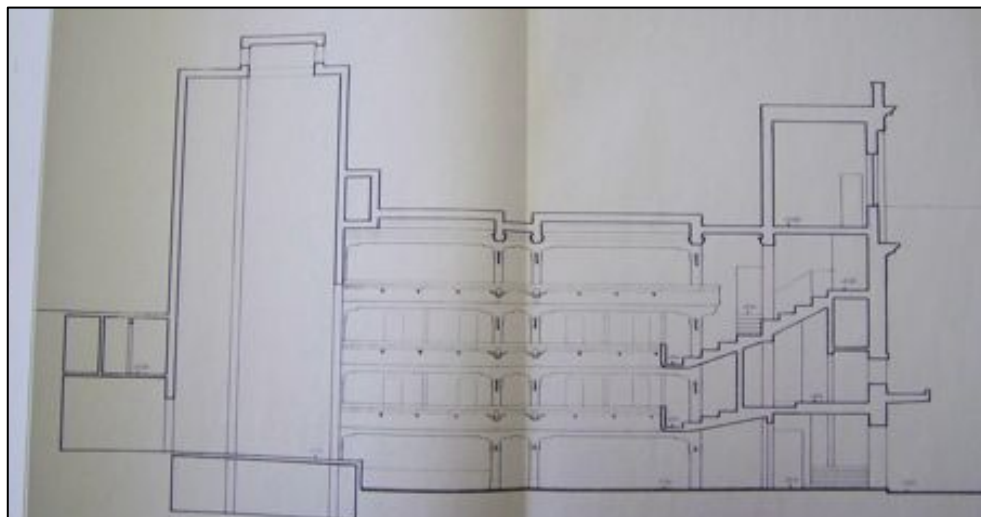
Sezione trasversale, 1994 (ASBAPSAE Ce-Bn, f.1040).
